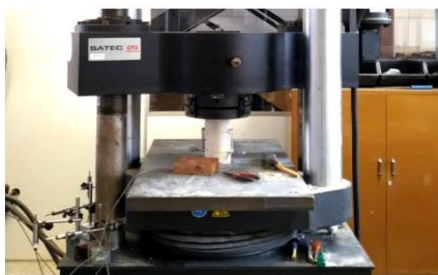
Ensaio de viga mista de aço e concreto em temperatura ambiente
